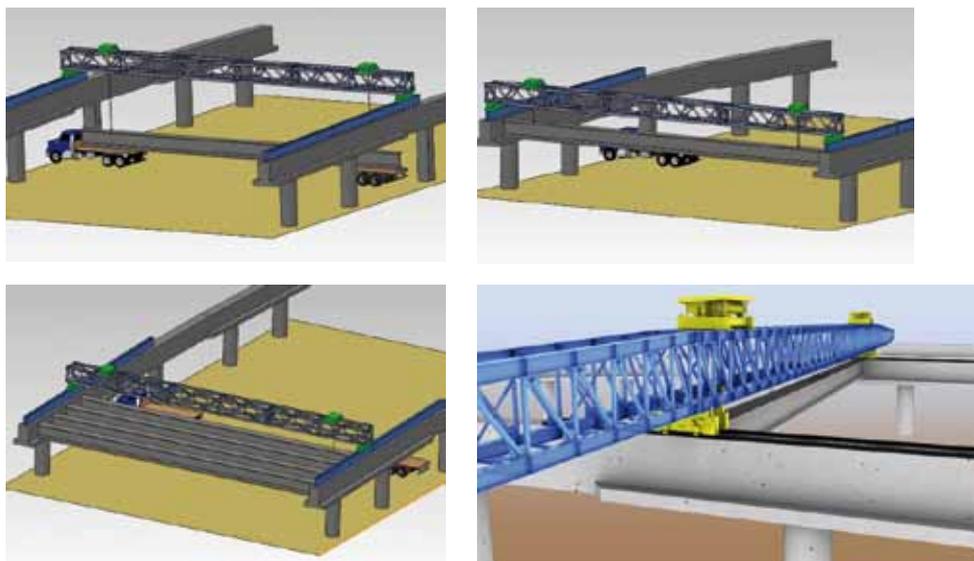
Esquema del proceso de colocación de vigas bajo estructura en nivel 3
